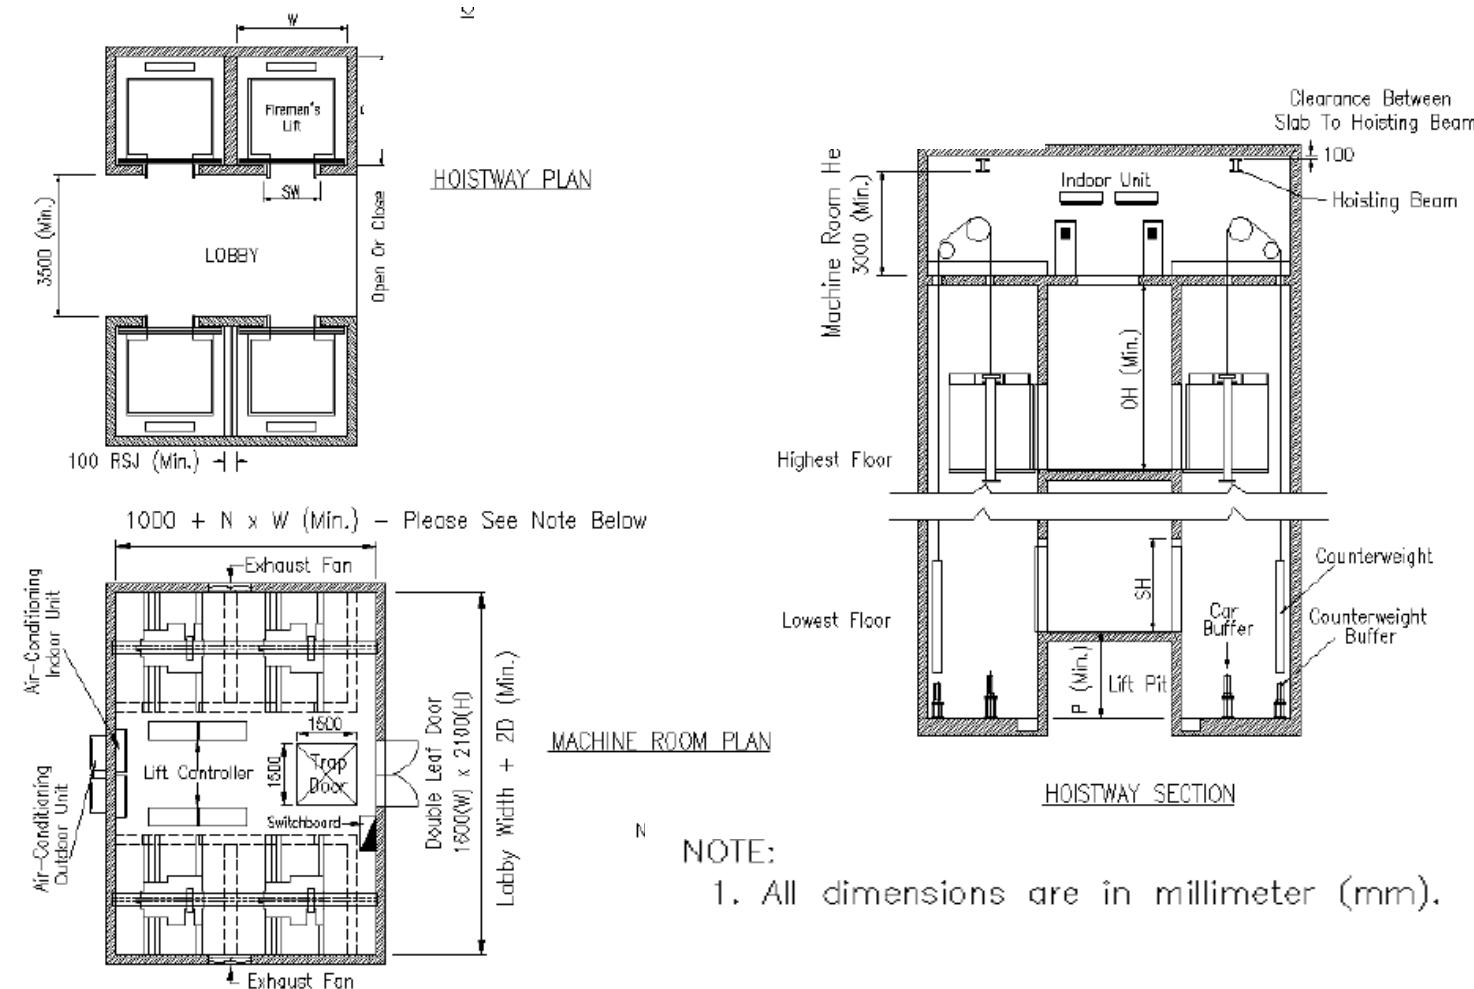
Lift Layouts Alcove Arrangements
